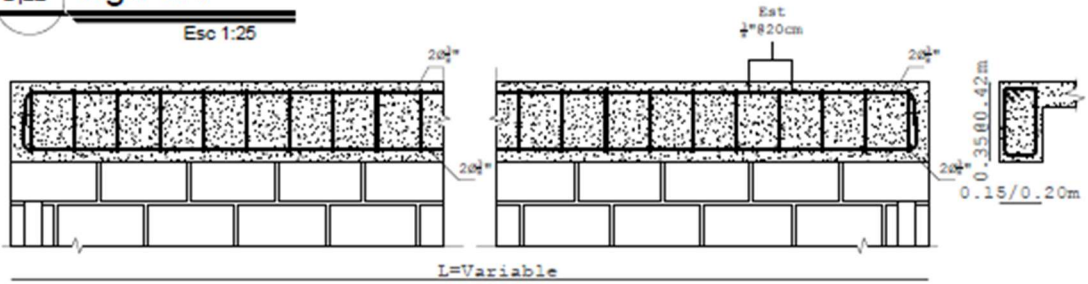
Diseño Estructural para Vivienda en Mampostería – Detalles de Muros
